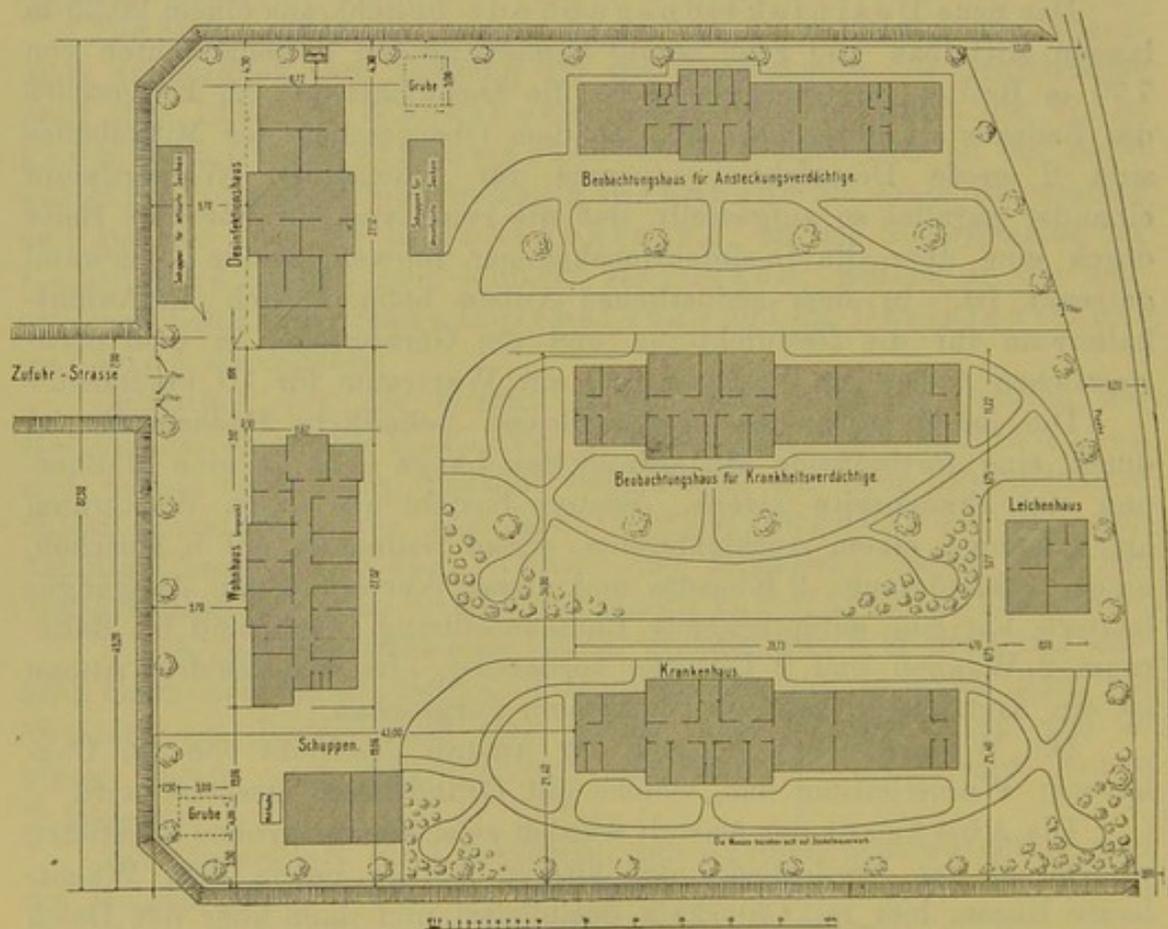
Grundriß der Quarantäneanstalt in Bremerhaven.
